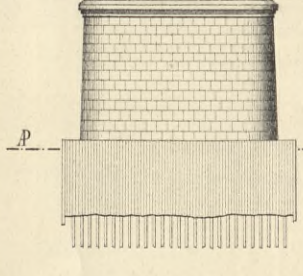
Zijaanzicht Pijler 2 (1 à 400)
